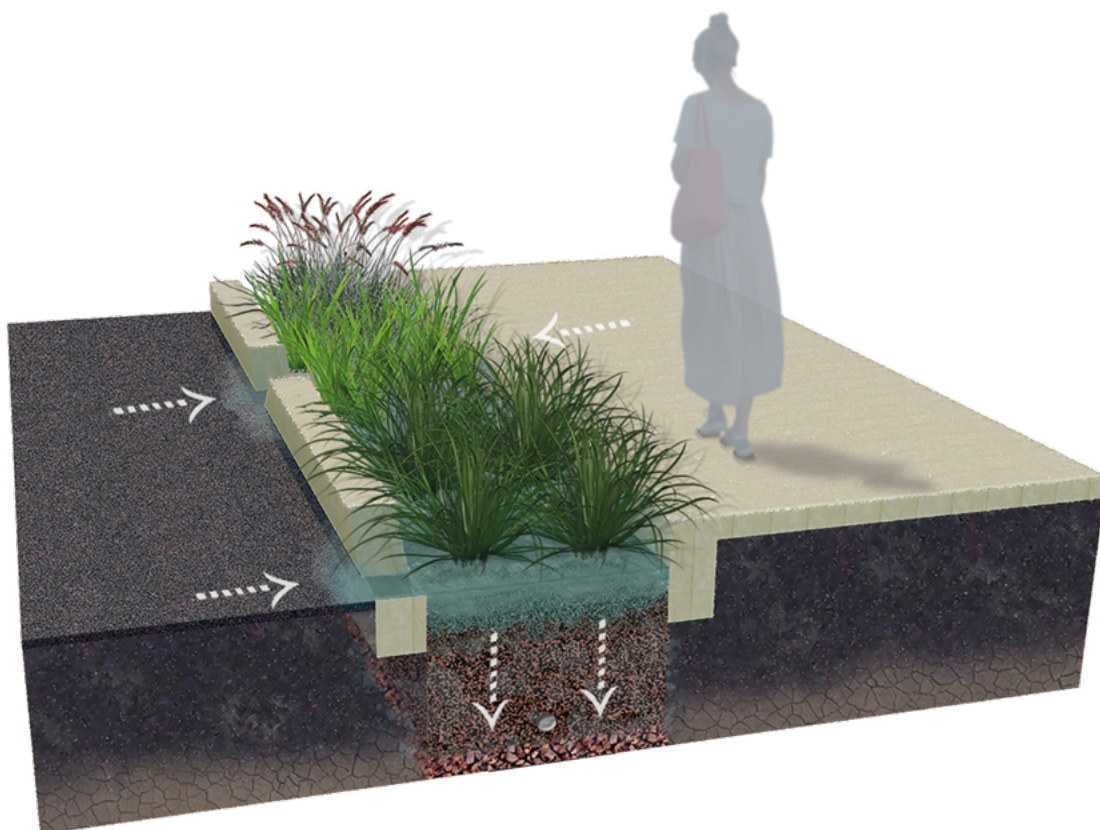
Placa explicativa de um canteiro pluvial
